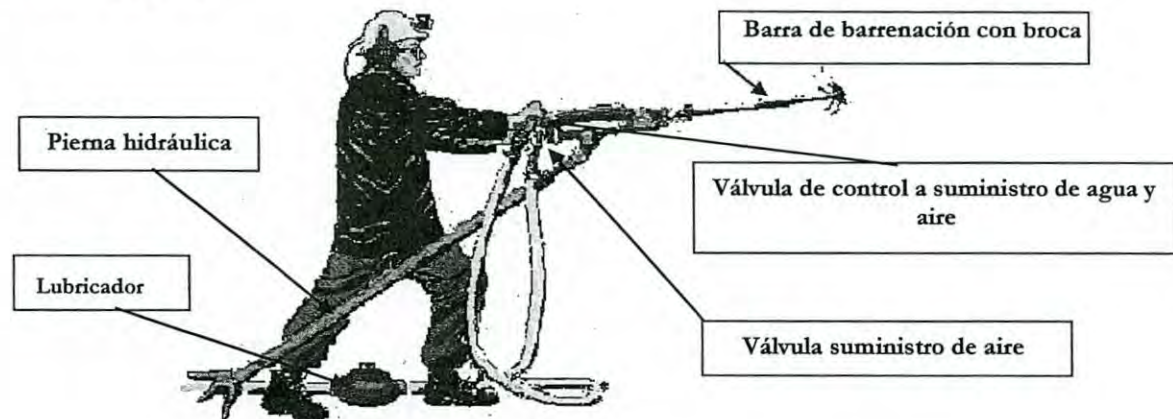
Se muestran los principales componentes en el sistema de la máquina neumática de pierna.
